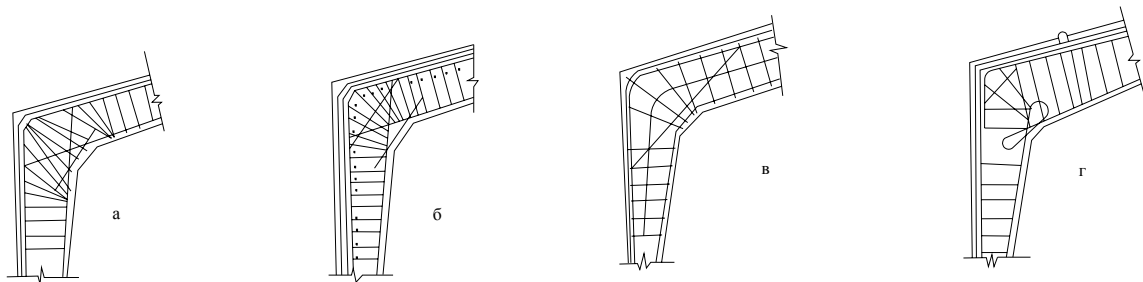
Схема армування вузлів стику стійок з ригелями:
